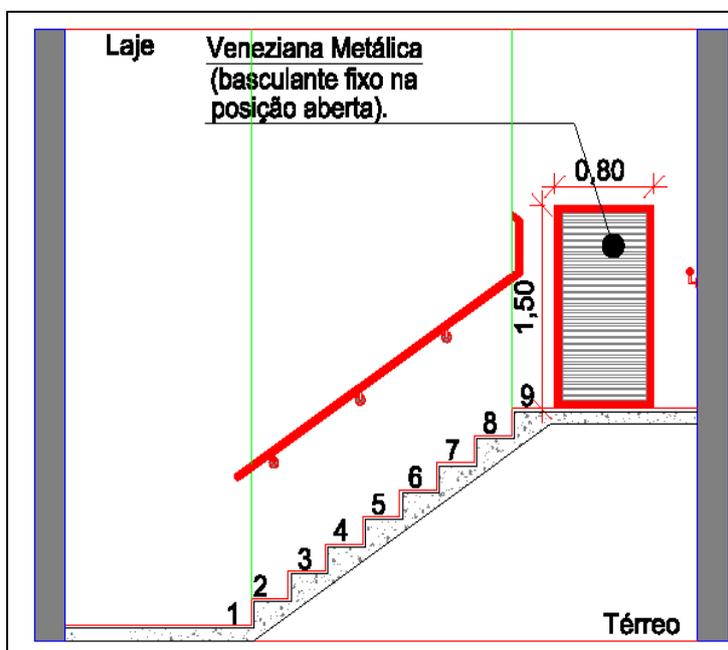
Corte da ventilação da escada protegida (pavimento térreo)
